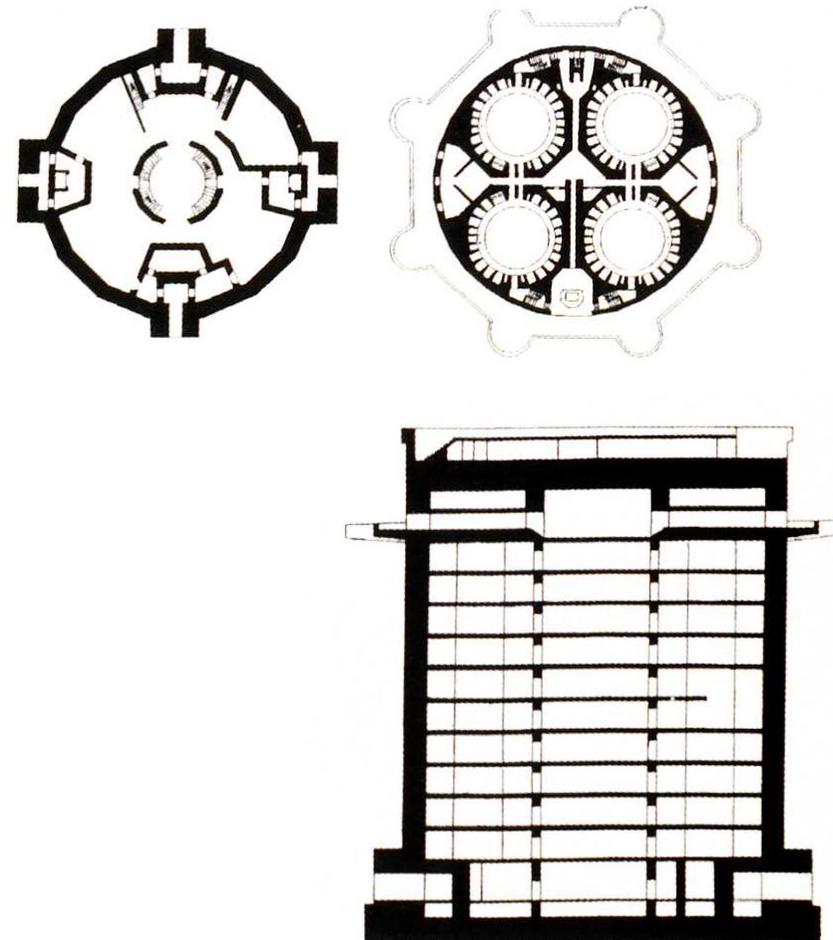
Pianta piano terra, pianta ultimo piano e sezione della torre GVII.
